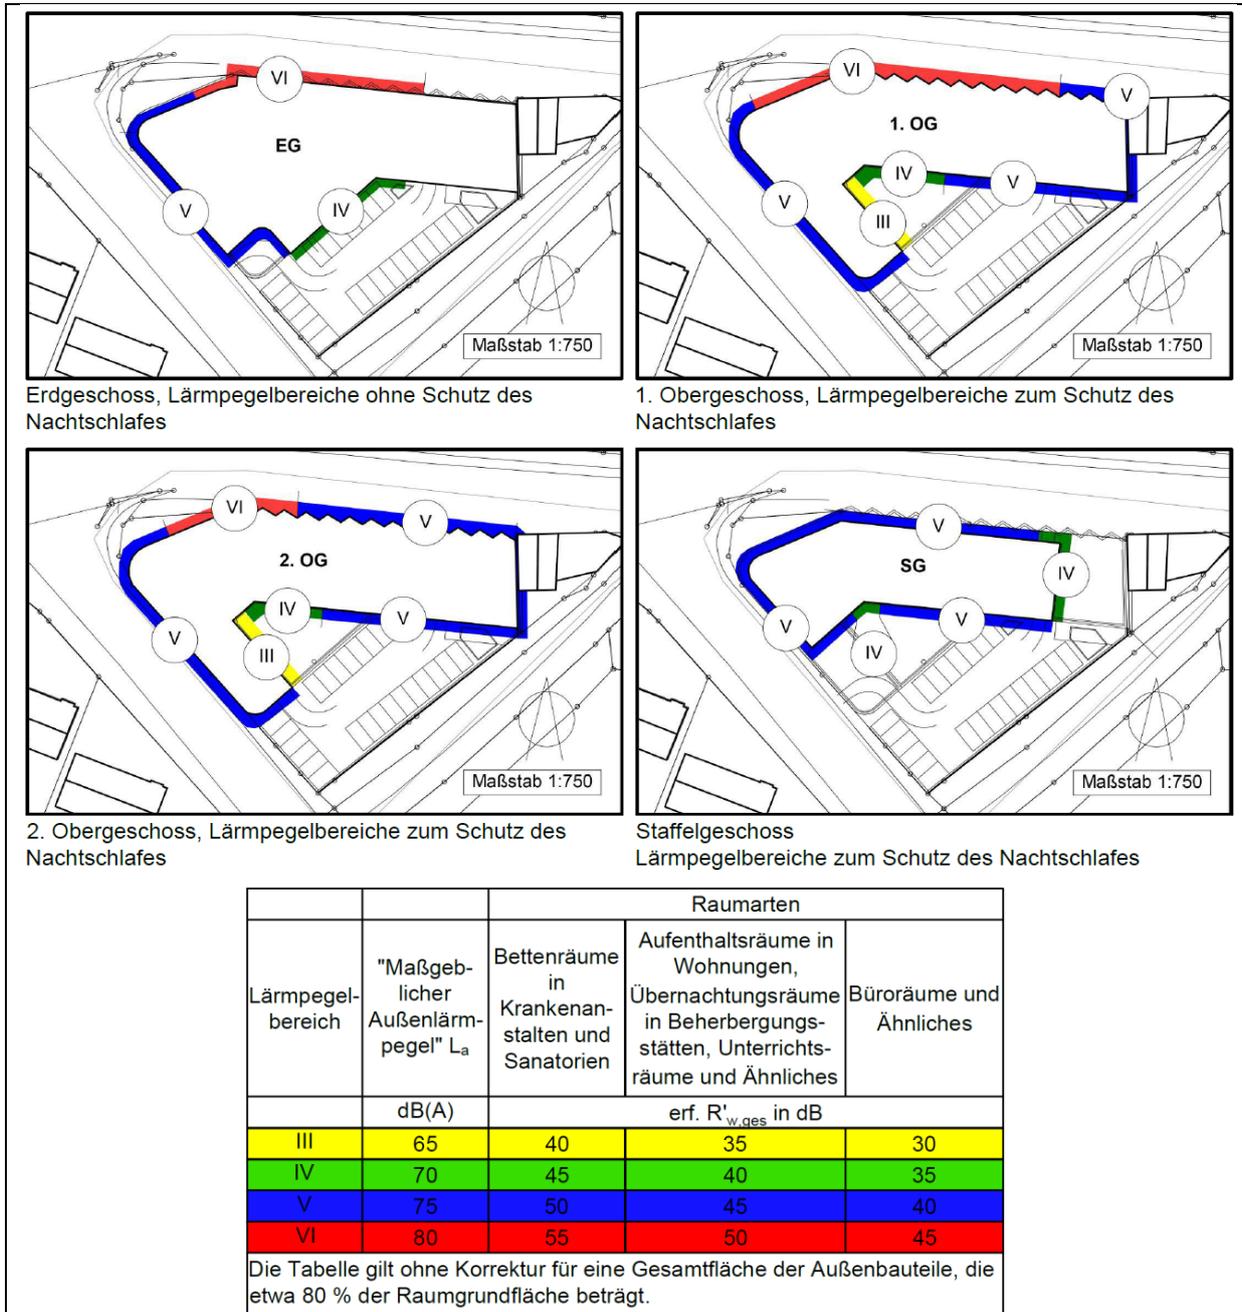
Gebäudelärmkarten mit den erforderlichen Lärmpegelbereiche an den jeweiligen Außenfassaden
